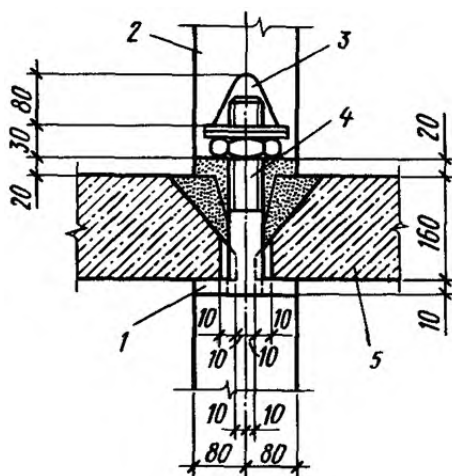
Конструкция соединения панелей внутренних стен и перекрытий:
